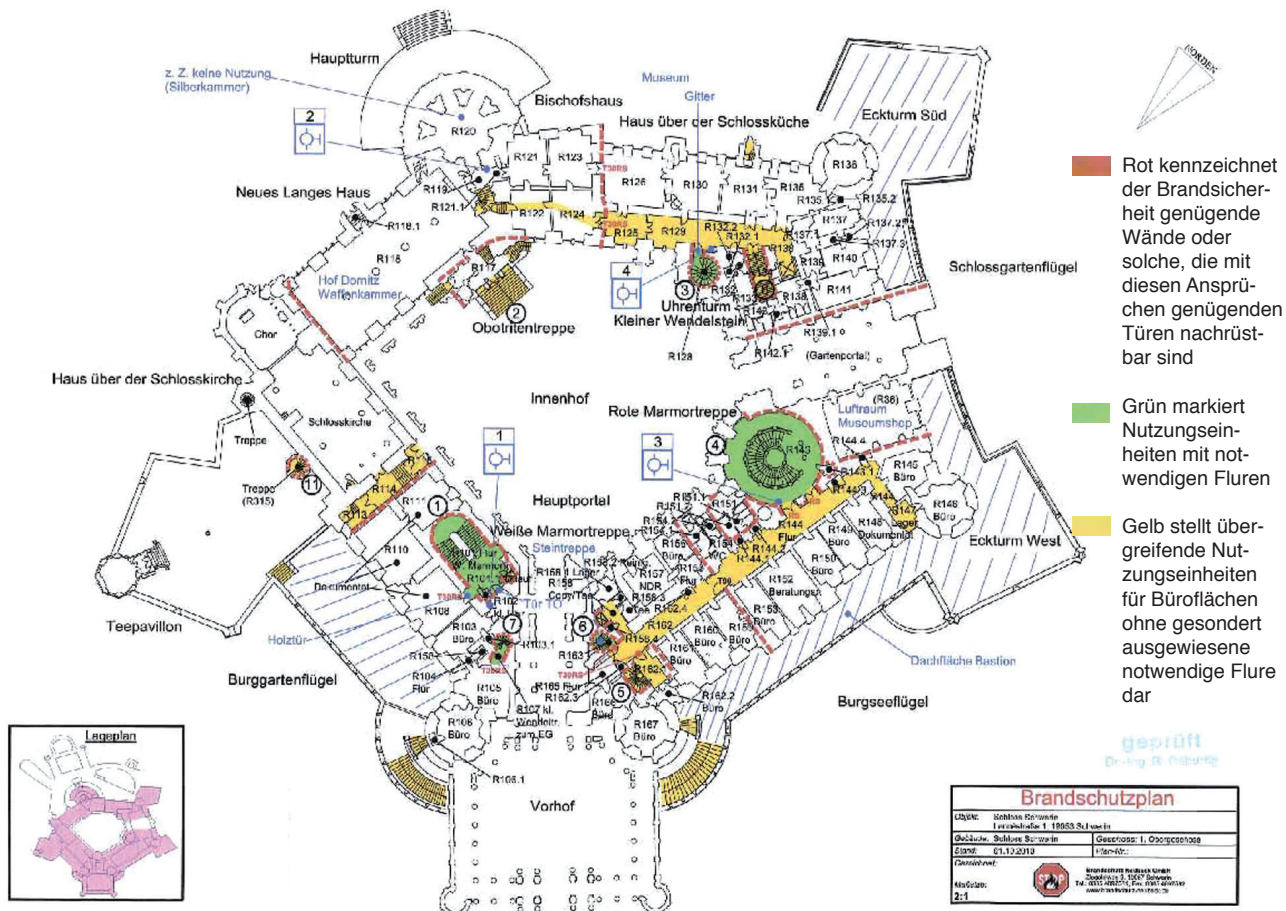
Grundriss des Erdgeschosses⁵.
